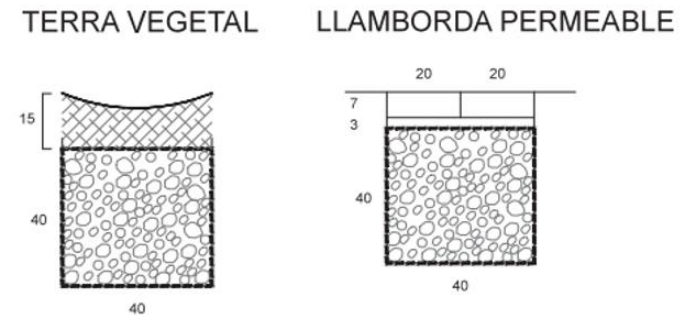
Tipos de pavimentos permeables incorporados en la plaza de la Ermita de San Jerónimo.
